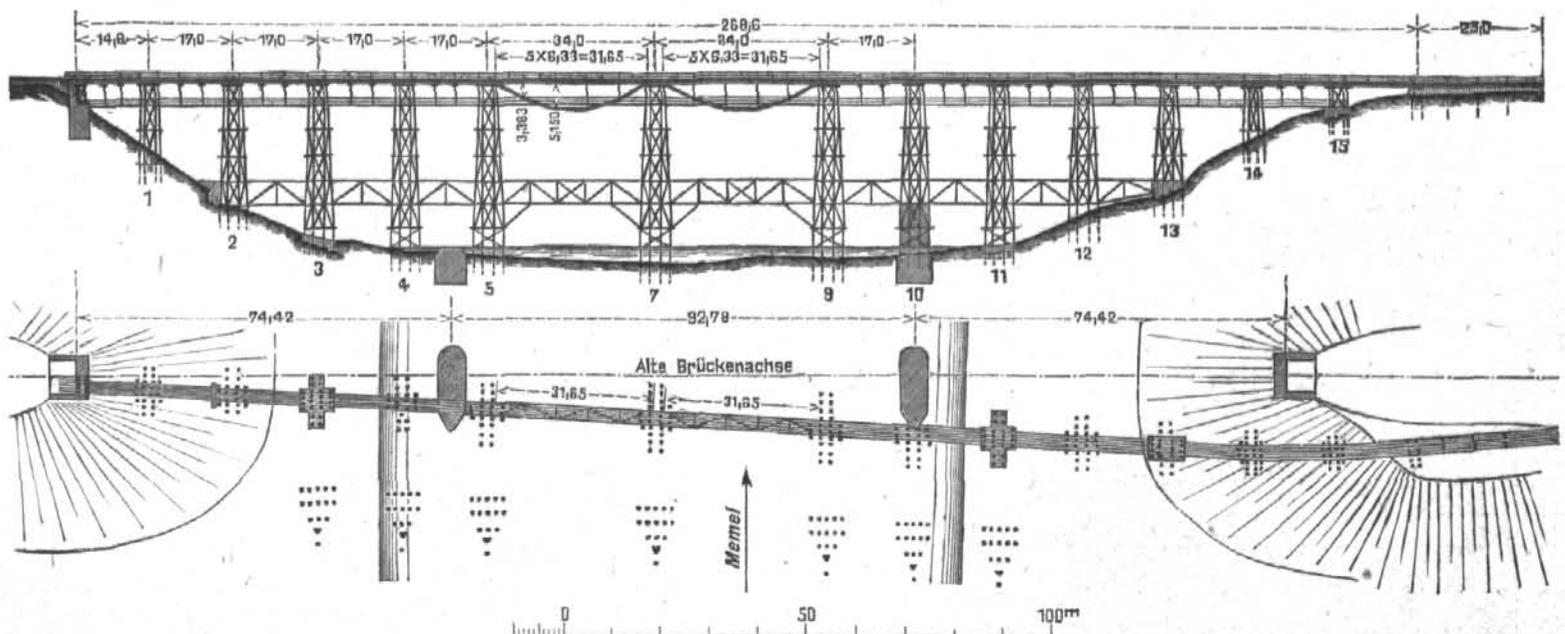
Längenschnitt und Grundriß der Brücke bei Olita.
